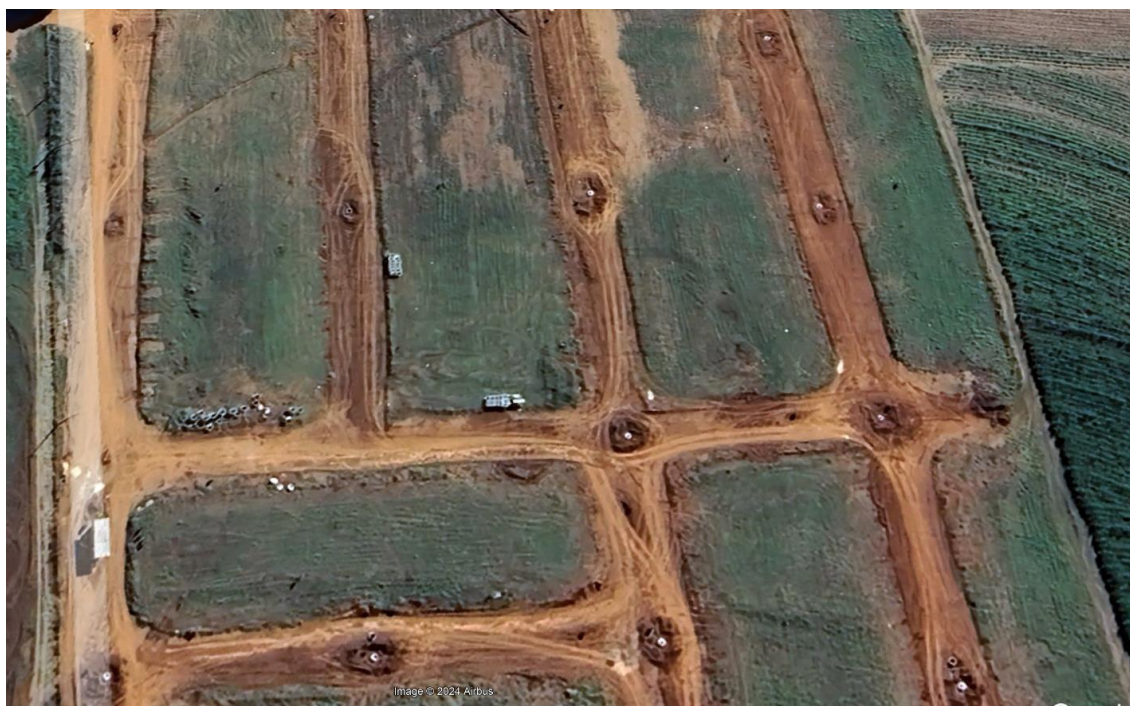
Loteamento sendo implantado. Notar a abertura das ruas e obras da galerias pluviais e rede de esgoto.
